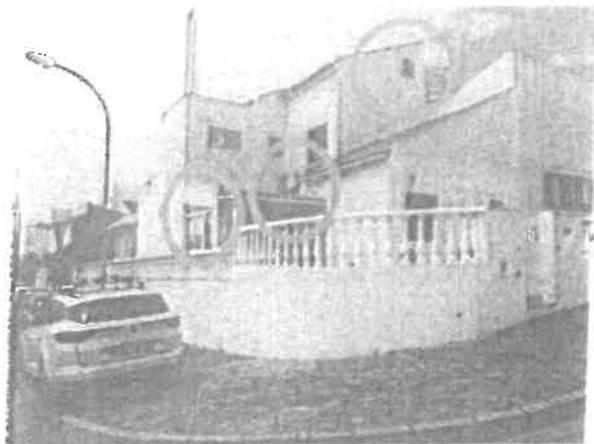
Vão de janela, aparelho de ar condicionado e encerramento da zona de entrada
